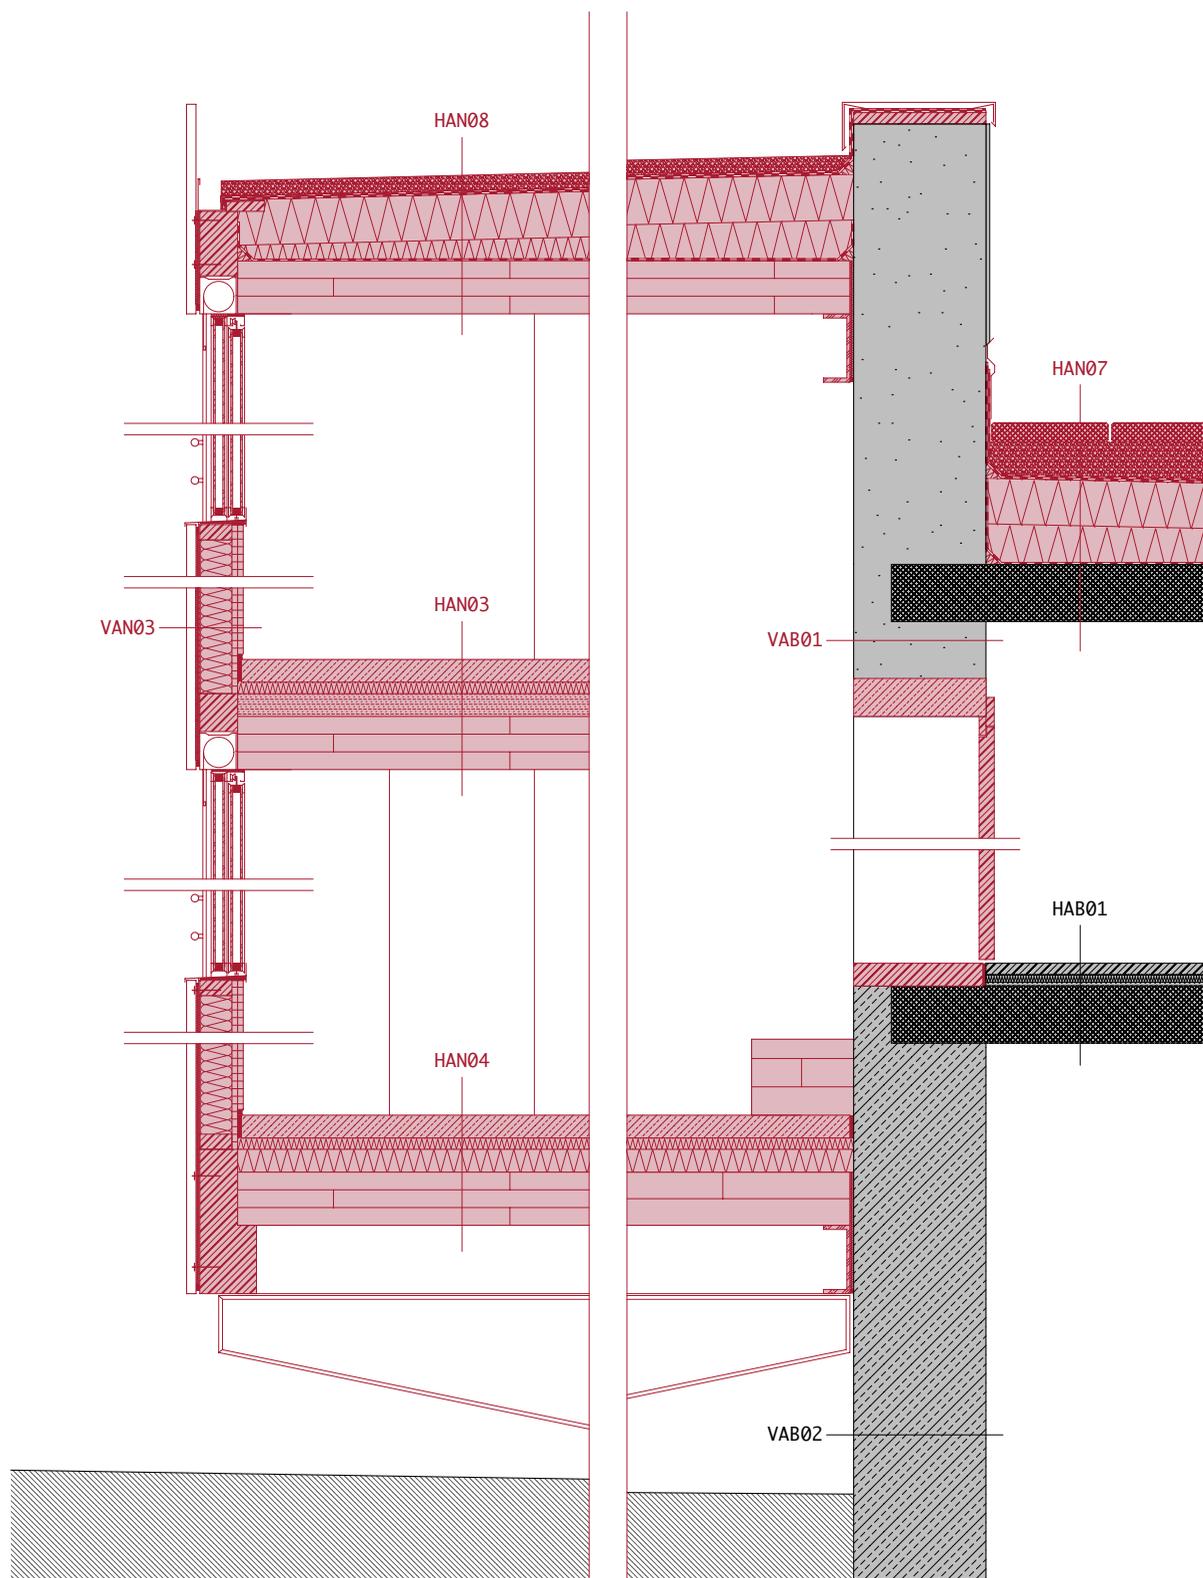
Detailschnitt durch Wintergarten und Bestand, Maßstab 1:20, Eigene Darstellung, 2024.
